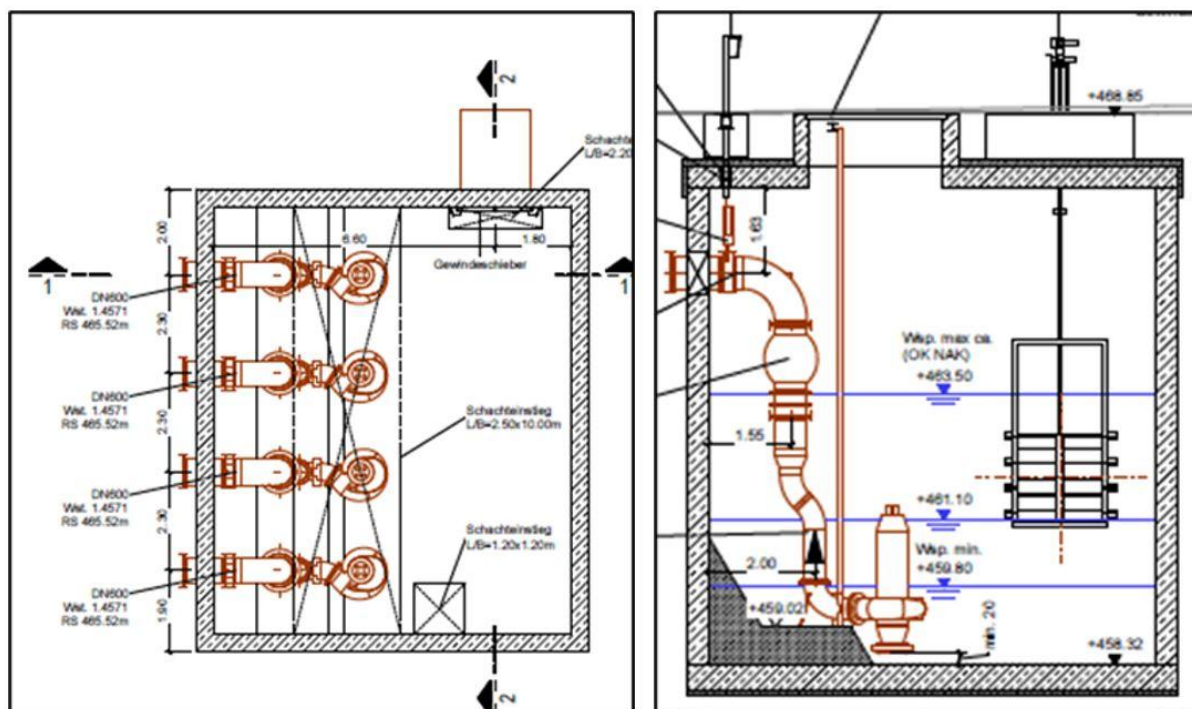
Grundriss/Schnitt Rückpasspumpwerk
